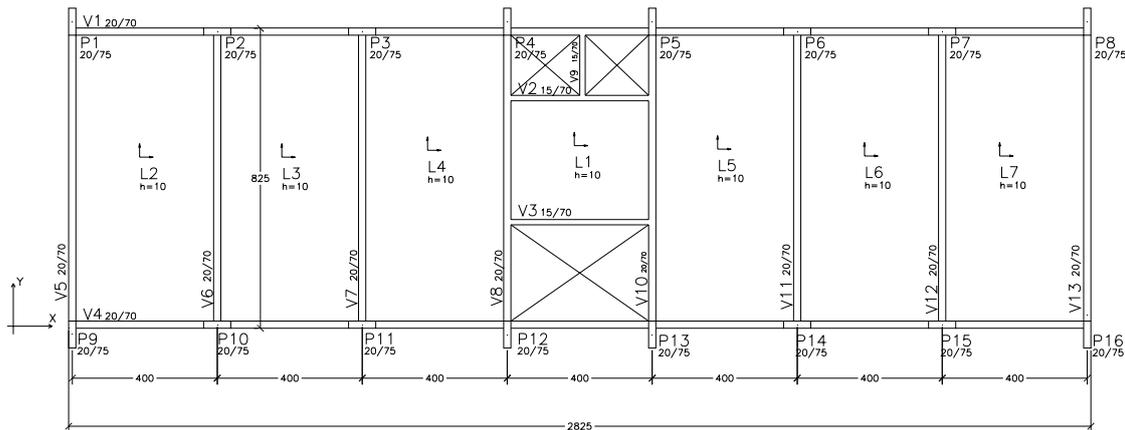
Planta baixa do pavimento tipo do Edifício 01 com a rigidez alterada
